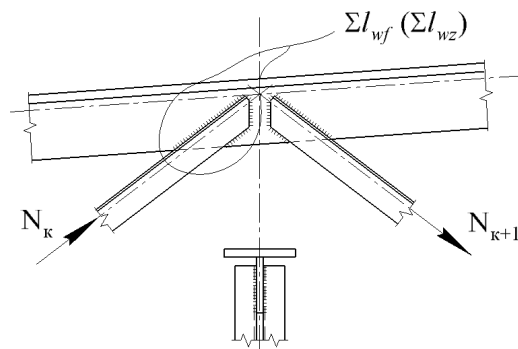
Узел примыкания раскосной решетки к верхнему поясу фермы из тавра (без дополнительной фасонки)
